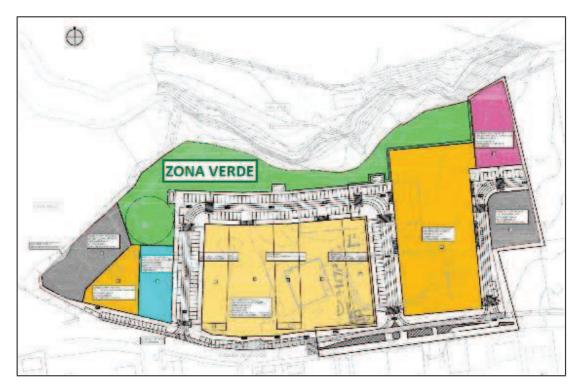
Detalle del Plano de Usos del Plan Parcial SU-NC\_R4
